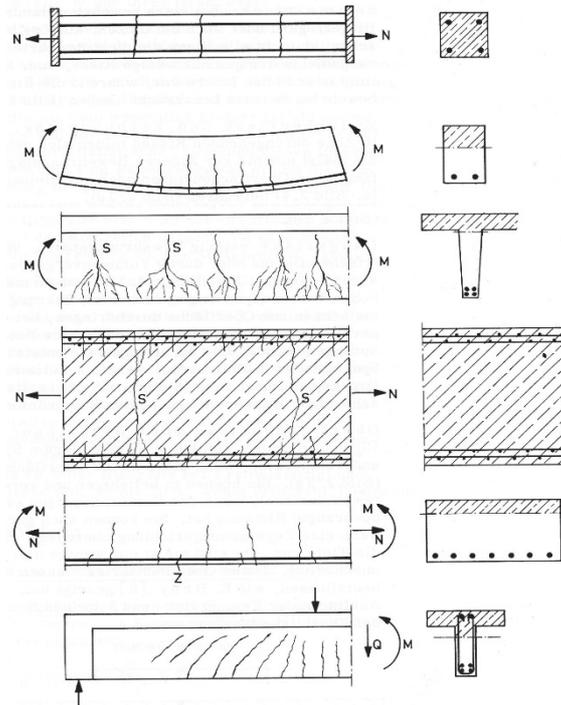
Statisch und konstruktiv bedingte Risse [10]
